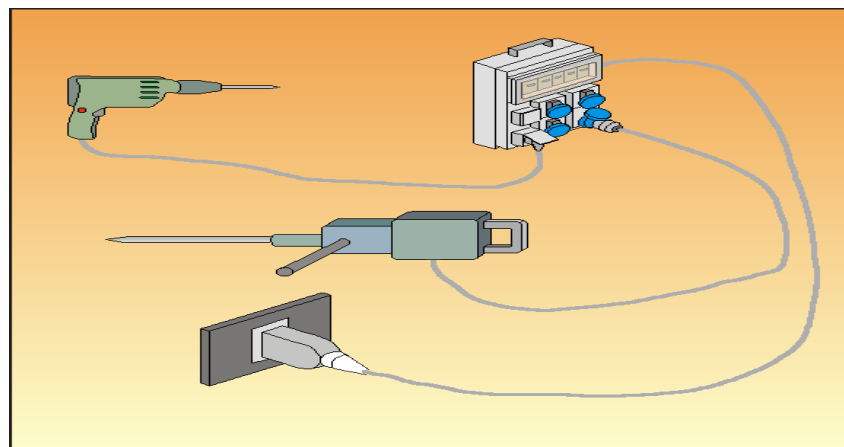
Quadretto alimentato direttamente dall'impianto esistente
